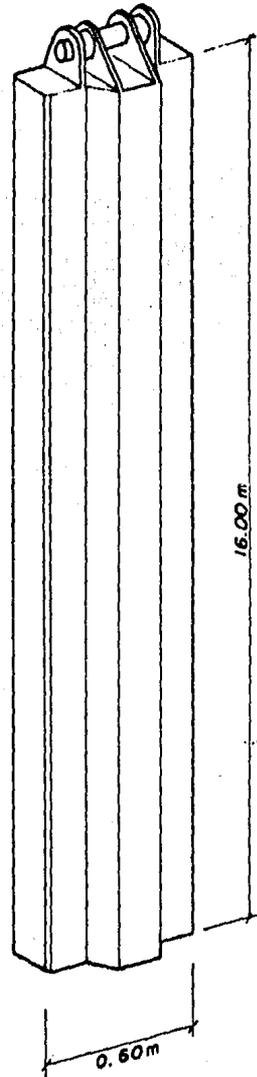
JUNTA METALICA PARA COLADO DE MODULOS DE MURO ADEME
